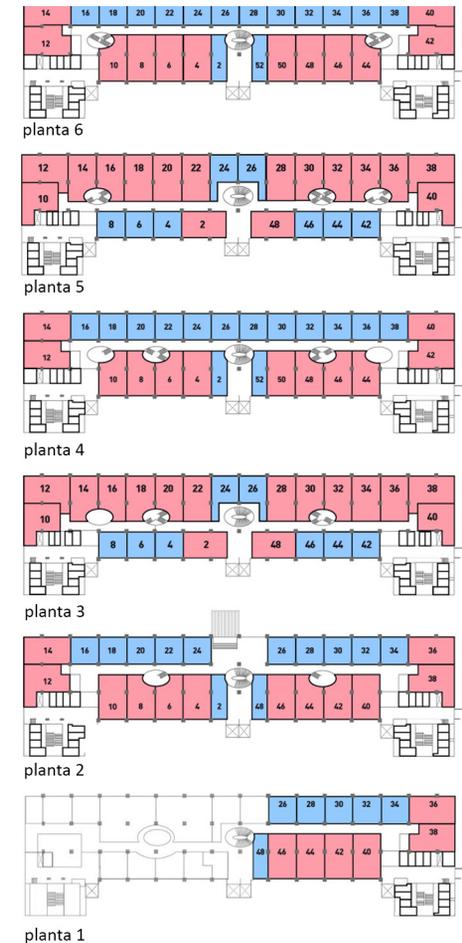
Plantas de distribución de las tipologías de viviendas, edificio Anton.
